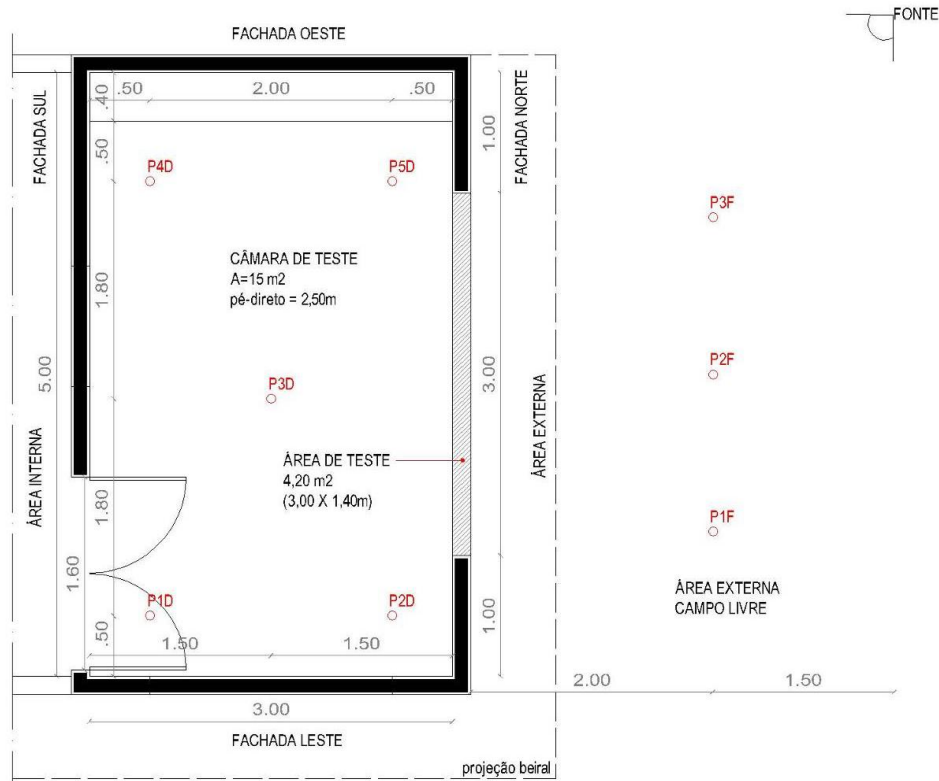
Planta da sala de teste com detalhe para a fachada onde foram aplicados os elementos vazados
